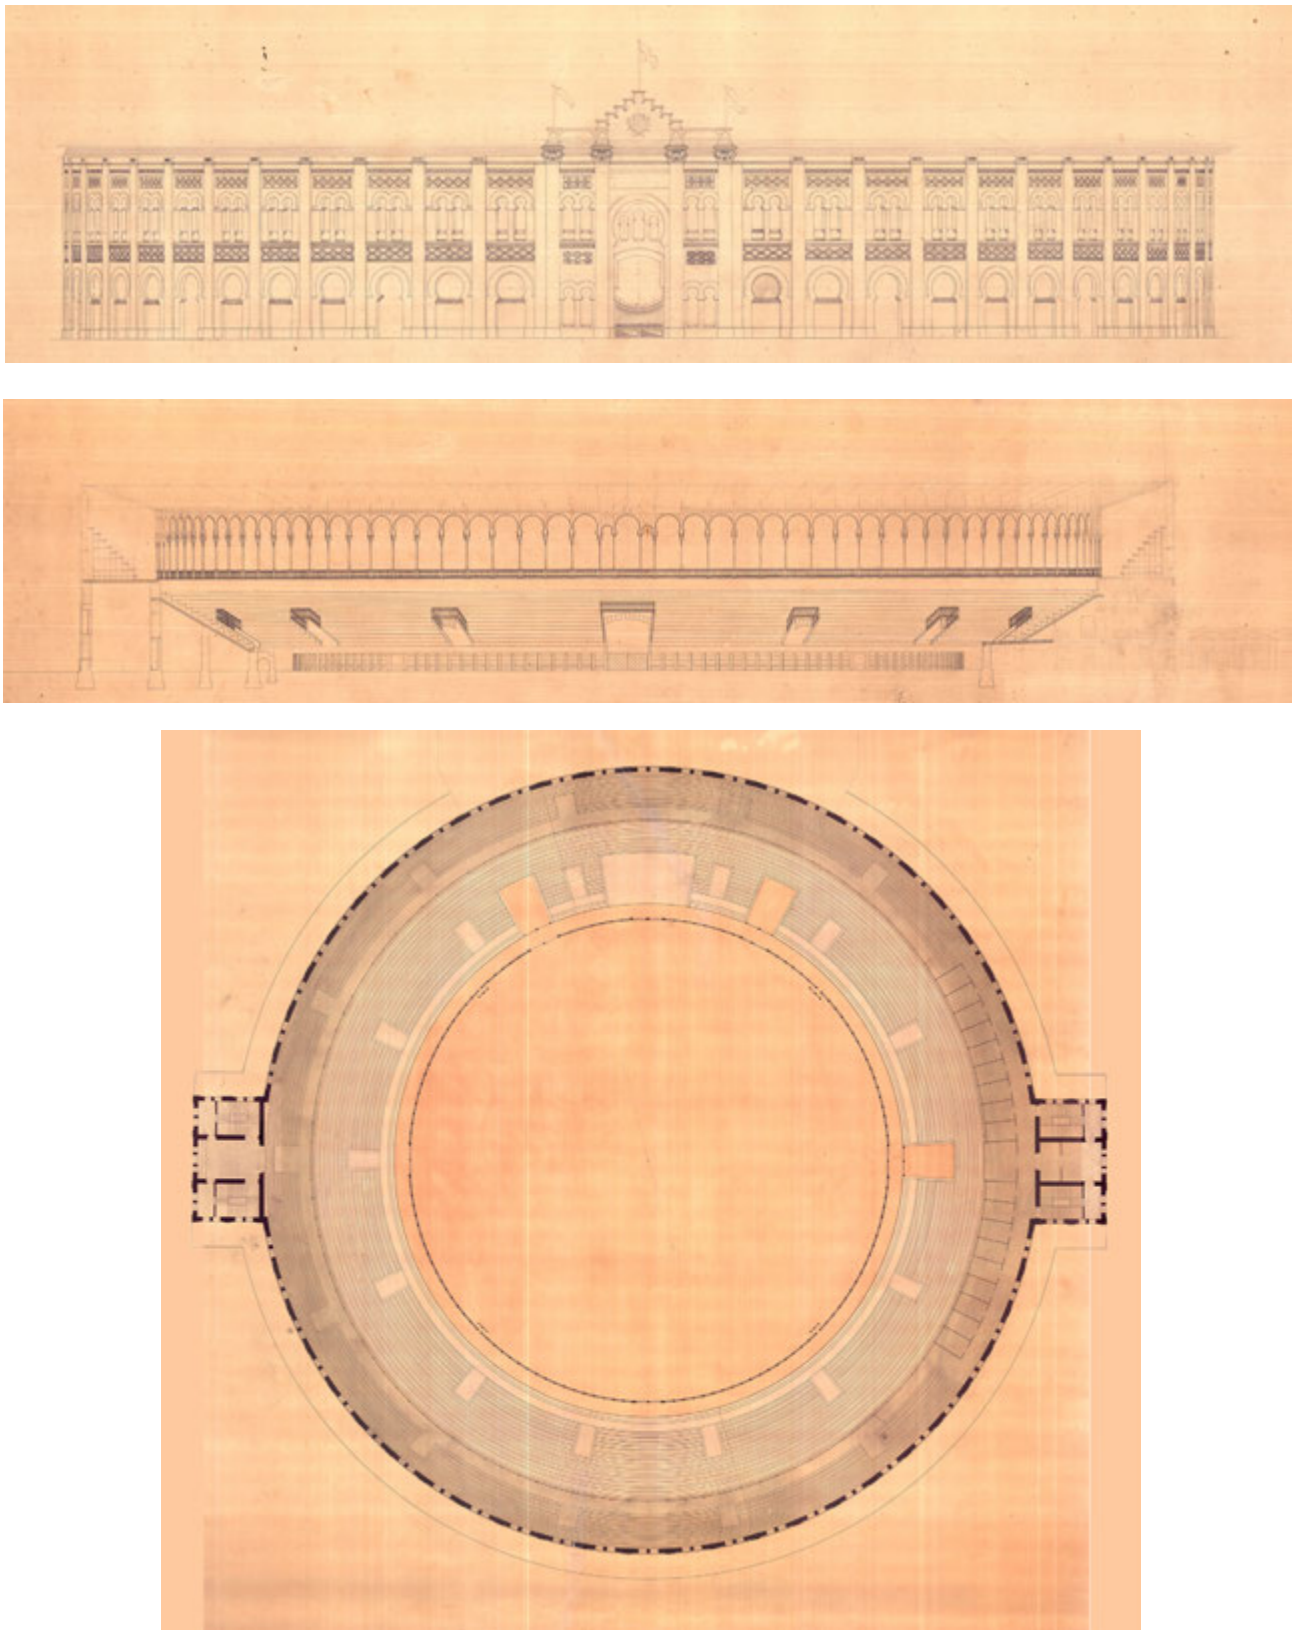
Francisco Hernández Rubio. Alzado, sección y planta de la plaza de toros no construida en Jerez de la Frontera. 1893.
